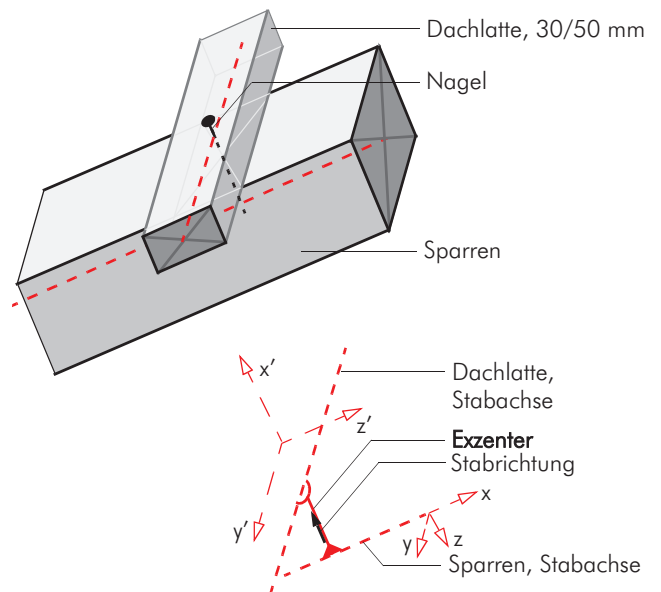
F.13 Modellbildung eines Dachlatten-Sparren-Knotenpunktes.
